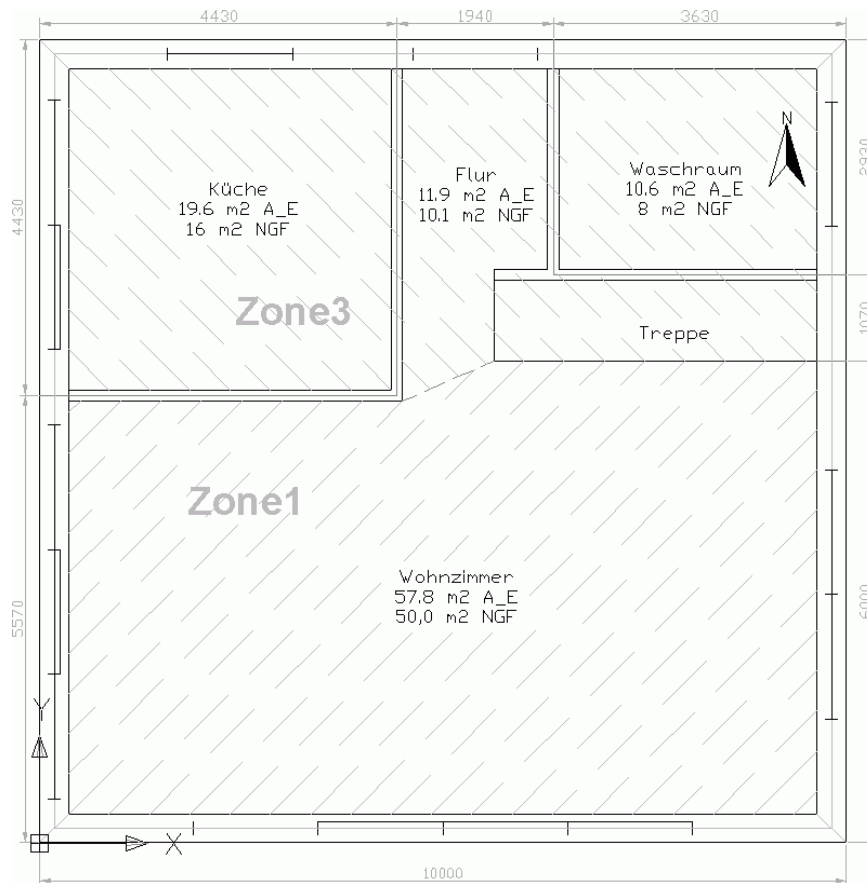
Grundriss des Minergie® Referenzgebäudes für das Erdgeschoss
